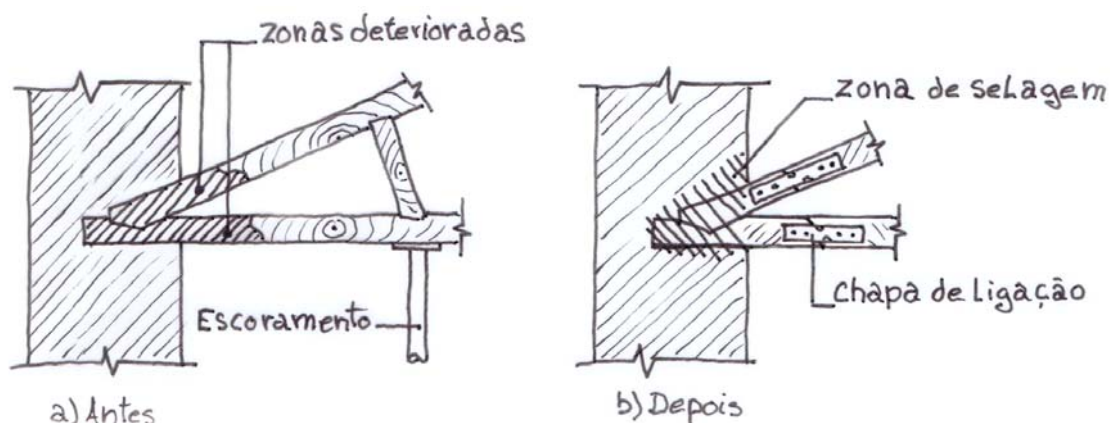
| Esquema de substituição de apoio de asna de madeira (adaptado de [2, 14]):
